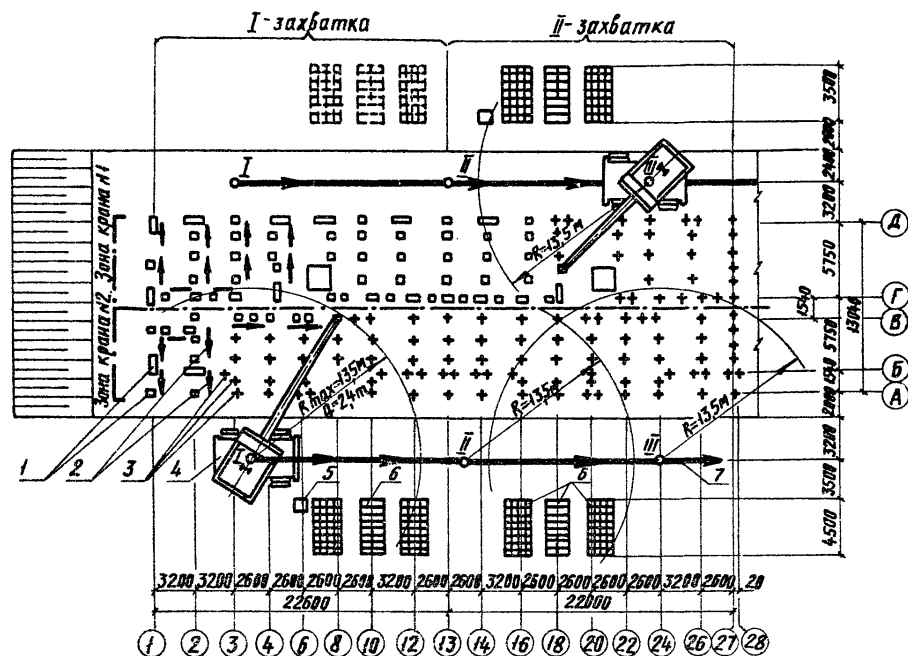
Схема организации работ по монтажу оголовков: I-смонтированные оголовки; 2-направление монтажа; 3-забитые сваи; 4-пневмокопальный кран К-150; 5-ящики для приема бетона; 6-штабеля оголовков; 7-ось движения крана; I, II, III-стоянки крана
